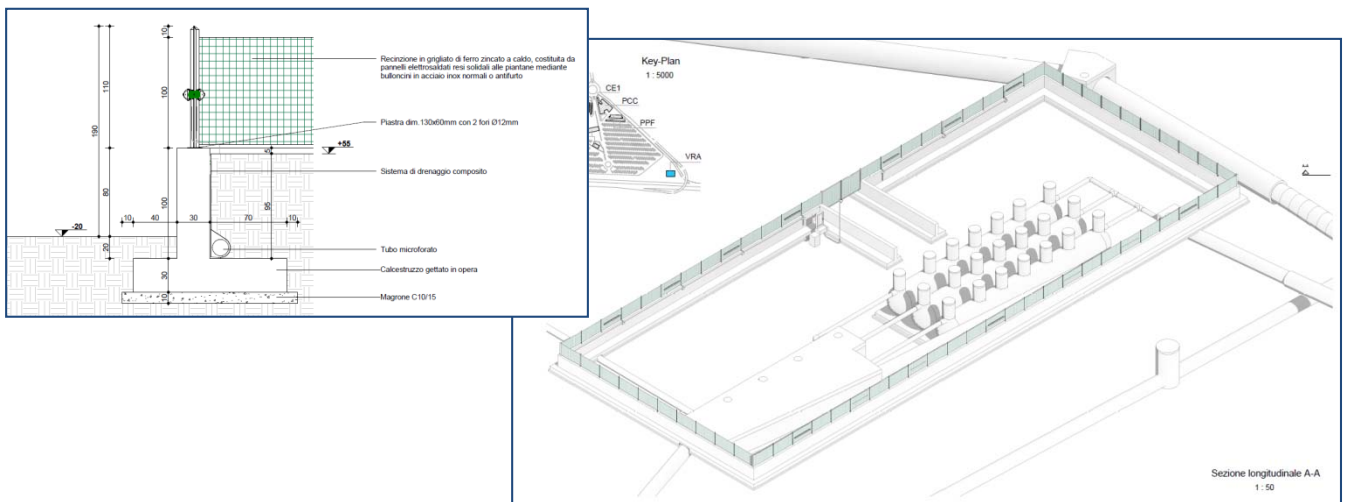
Muro di contenimento area impianto di trattamento acque di piattaforma - Schema prospettico
